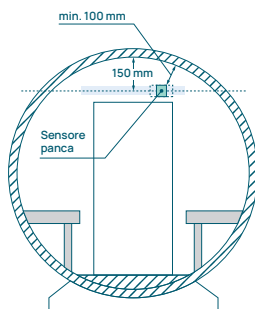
Installare il sensore panca nella sauna a botte sulla parete terminale circolare, sul lato opposto rispetto al riscaldatore.
